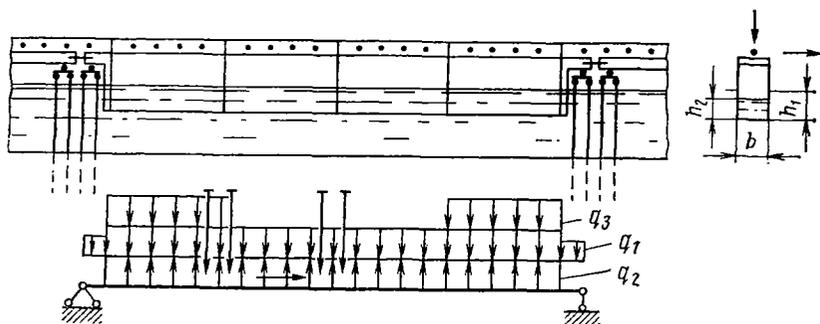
Схема к расчету выводной секции подкрановой эстакады
